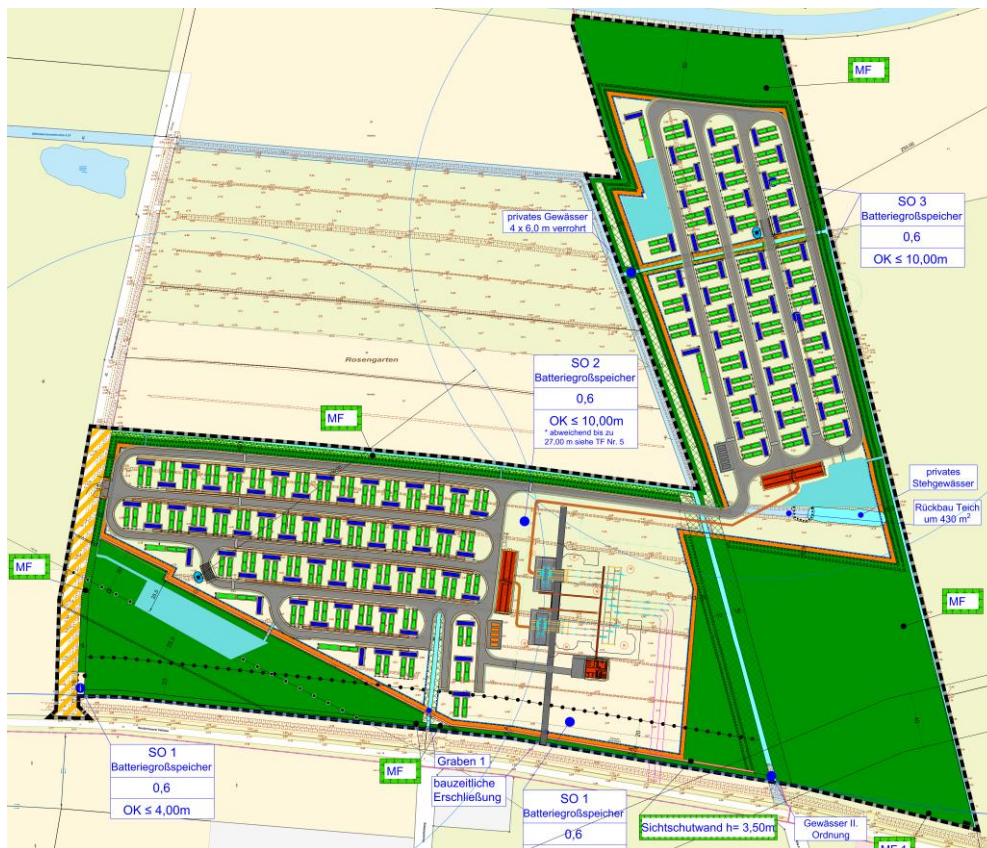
Lageplan 400 MW Batteriespeichereinlage Elsfleth
